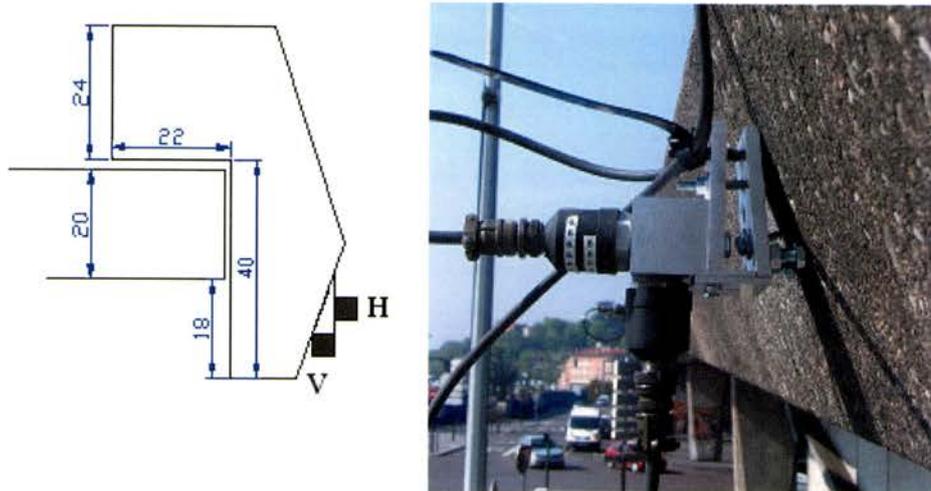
Coupe transversale au droit d'un mur d'une corniche et son instrumentation
